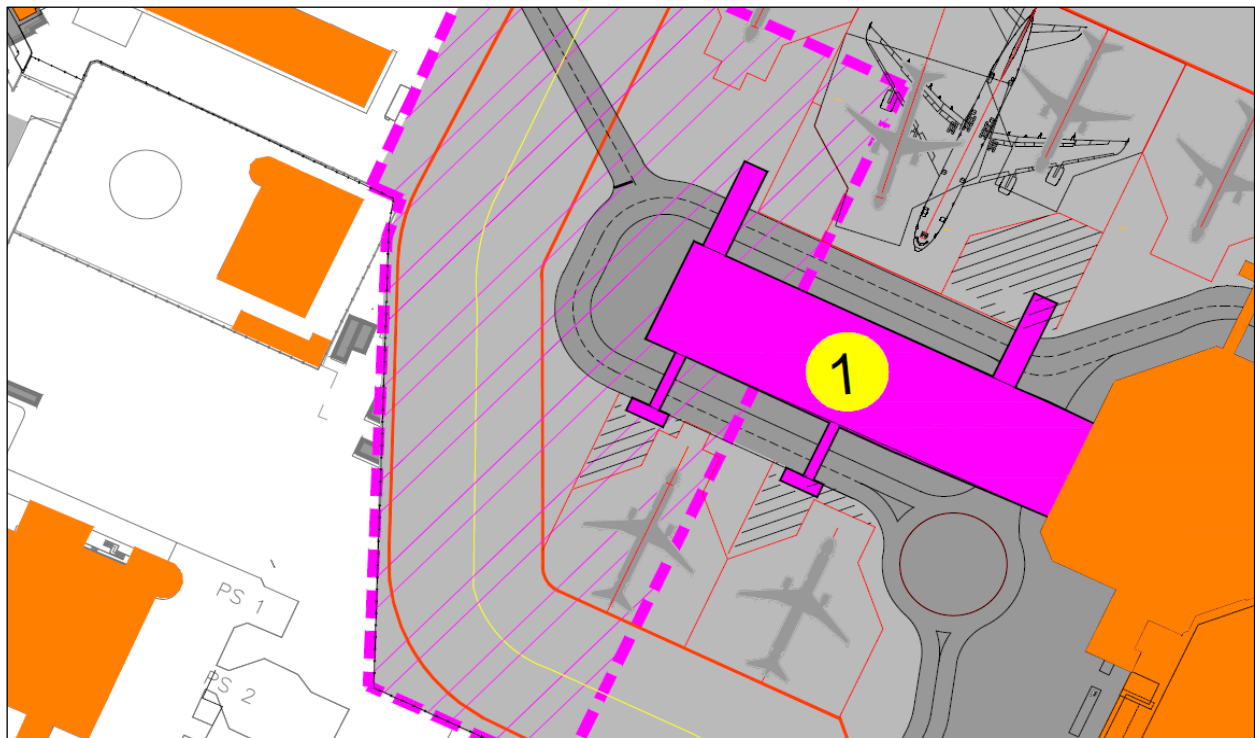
Estratto Master Plan – Intervento realizzazione Nuovo Molo Partenze
